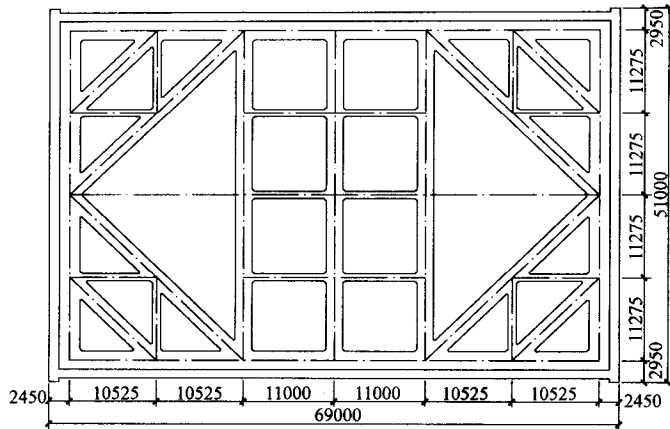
北锚碇基坑支护结构平面图 (单位: mm)
